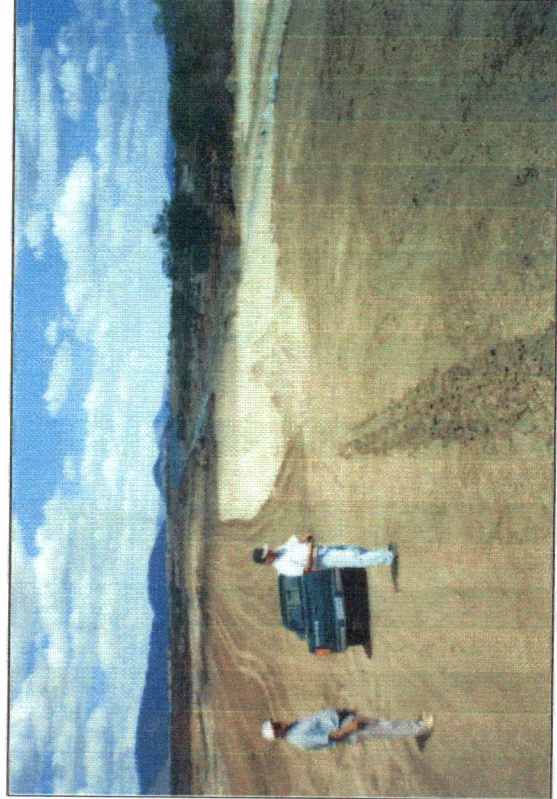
Parte central da barragem, após preenchimento do cut-off.
